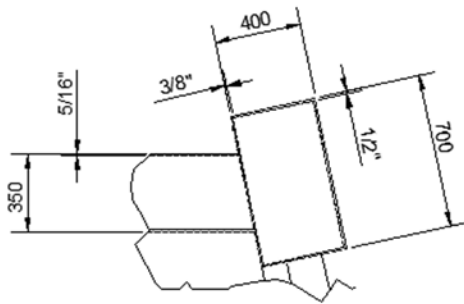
Sección Transversal Arco en unión con arriostramiento transversal horizontal.
